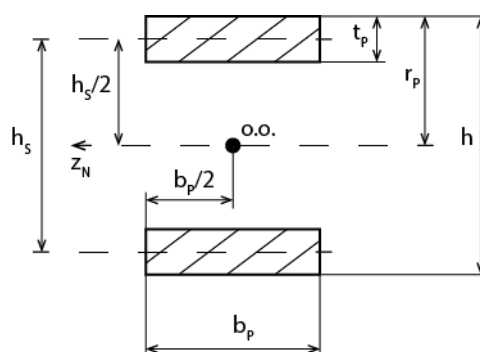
Uvažované silové uspořádání pro dimenzování pásnic
